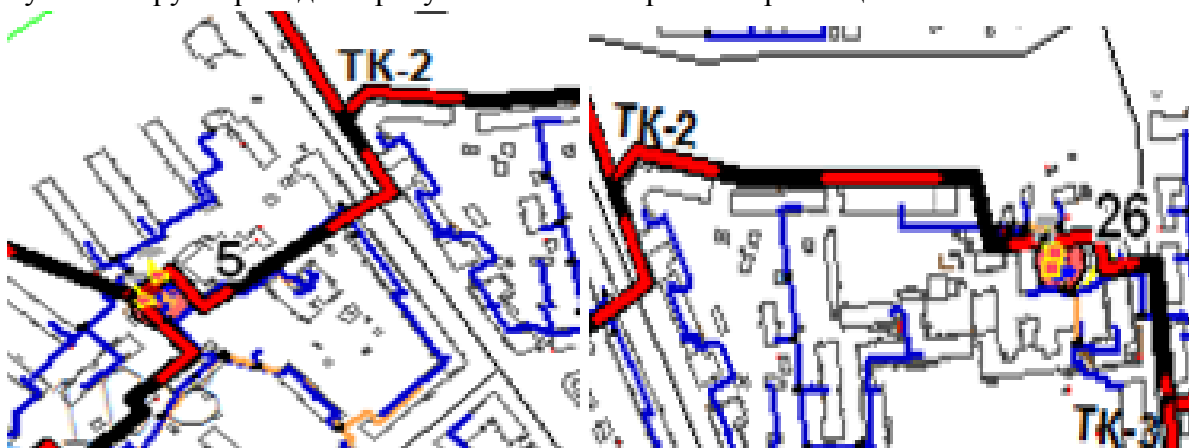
Схема прокладки трубопровода между котельными №5 и №26
